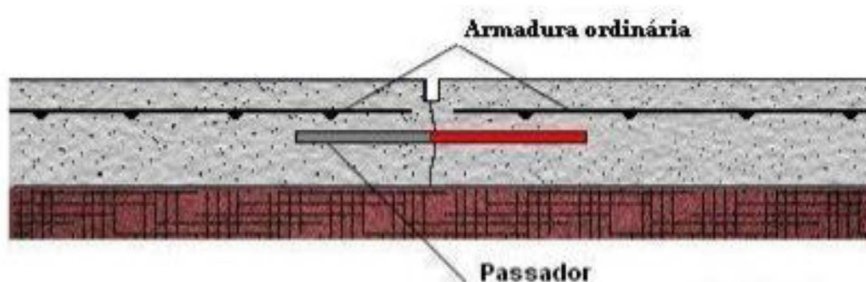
Laje de betão armado com passador (OLIVEIRA, 2000)
